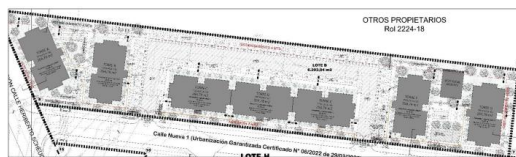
Plano planta – Lote B. Vivienda Santa Norma II
